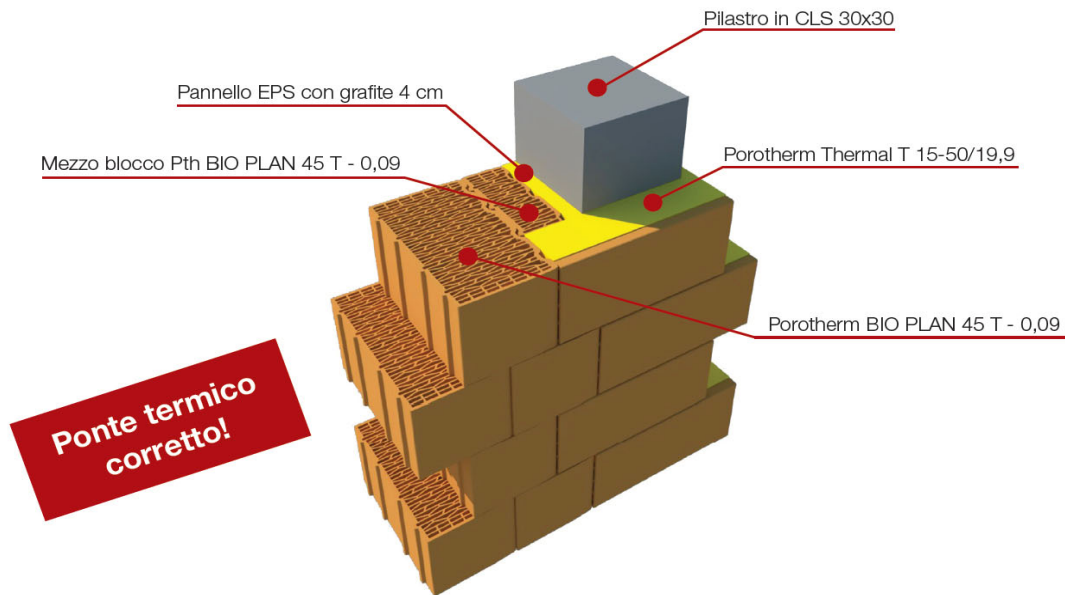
Dettaglio 3D della risoluzione del ponte termico in corrispondenza del pilastro.
